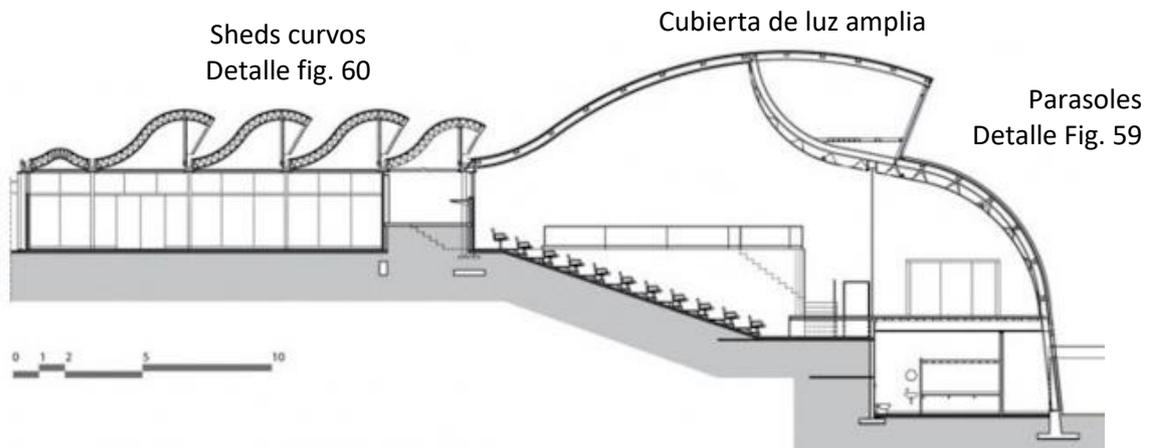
Corte esquemático donde se ve la variedad de sheds
